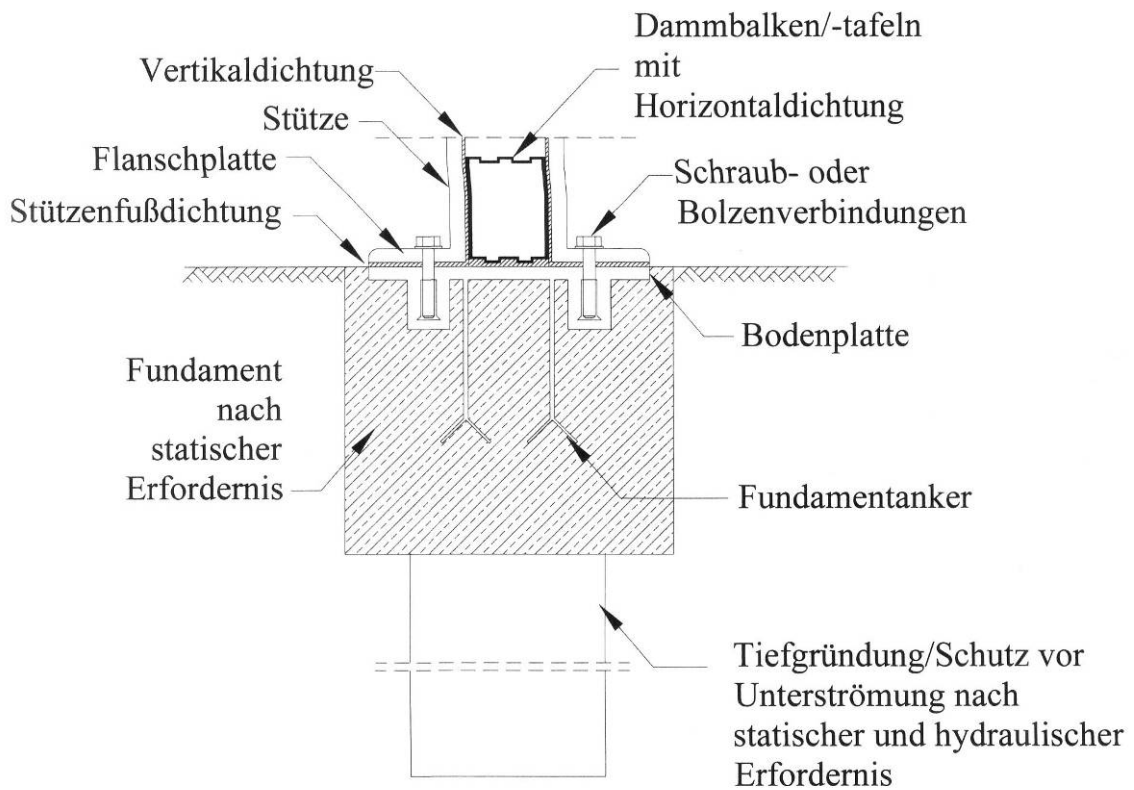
Verbindung einer Dammbecken/-tafelwand mit dem Untergrund [72]
